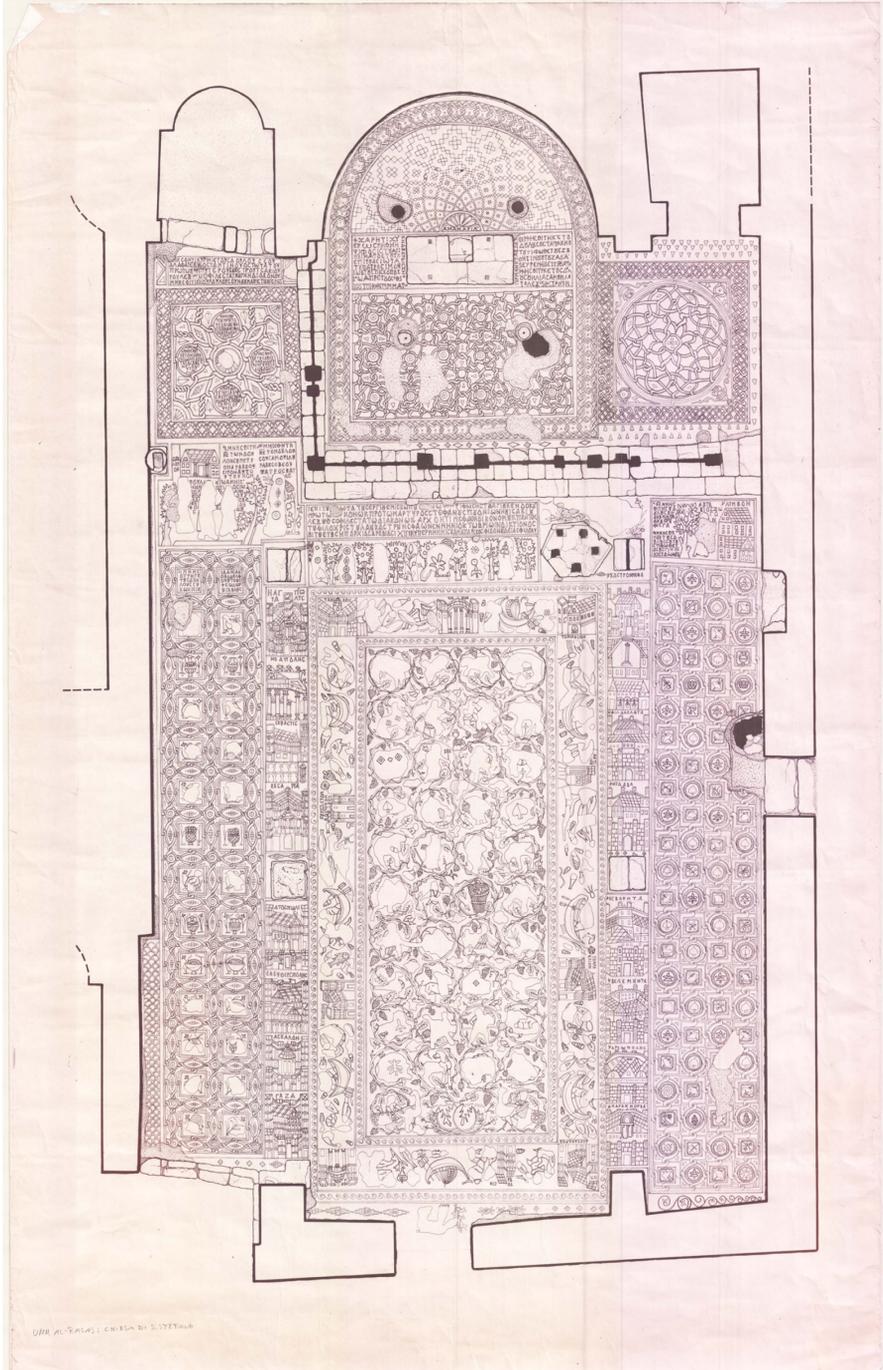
Grundriss mit Layout der Mosaiken, Stephanskirche, 8. Jh. n. Chr., Umm ar-Rasas, Jordanien.
